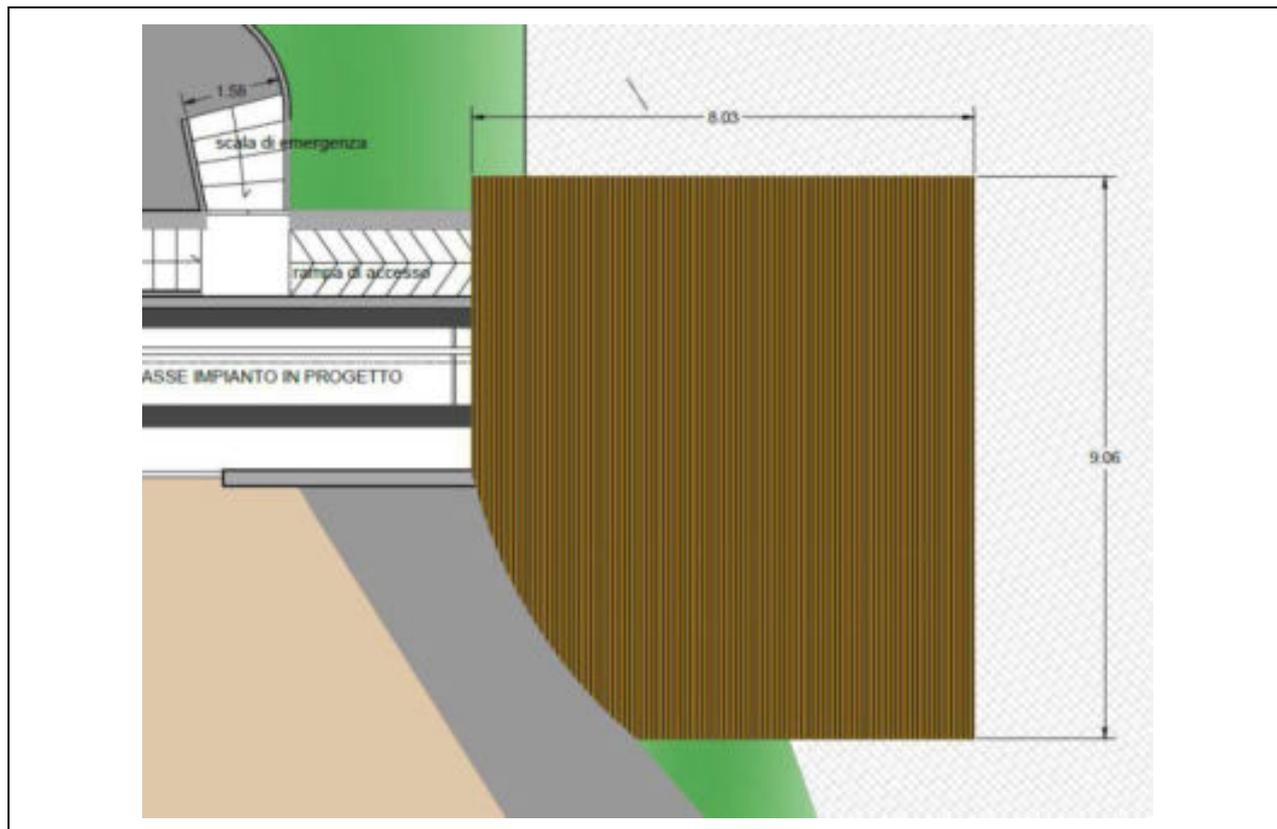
Piante Stazione di Monte (Elaborato EG23)
